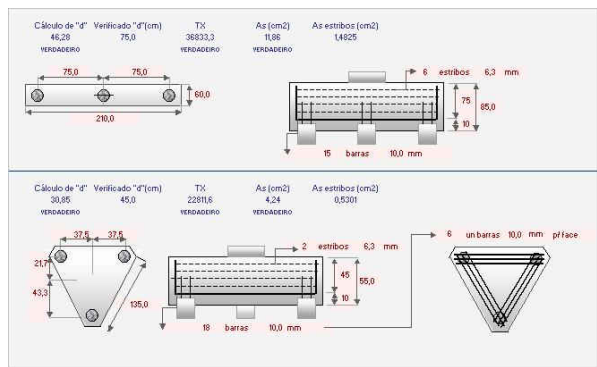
Desenho esquemático de bloco sobre três estacas e bloco concretado.
